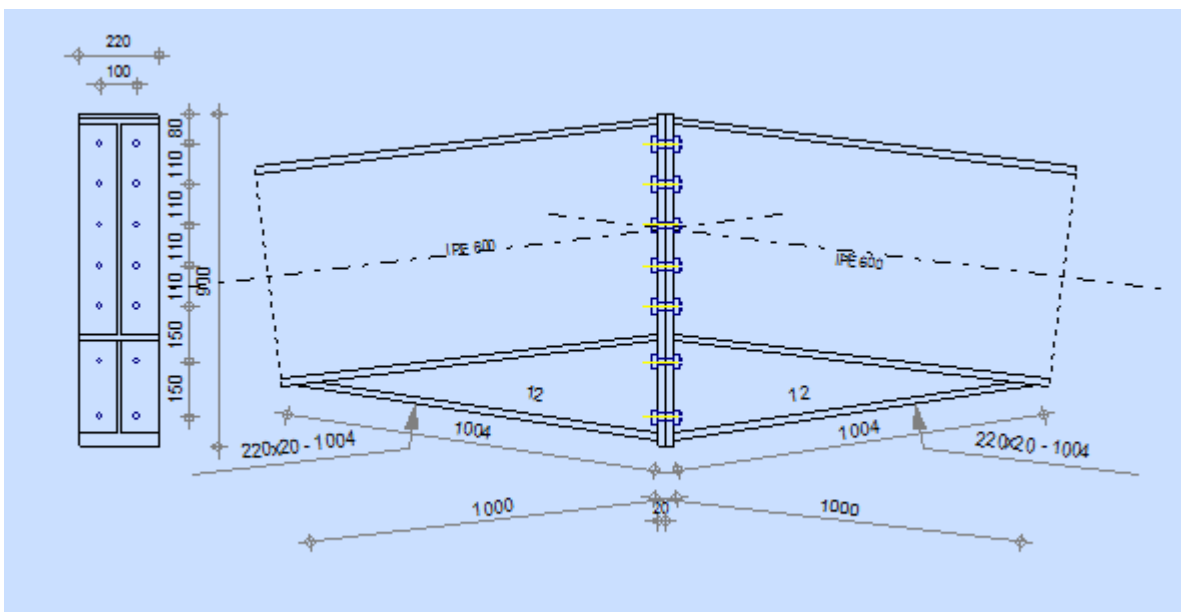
assemblage poteau Travers IPE600 –Travers IPE600
